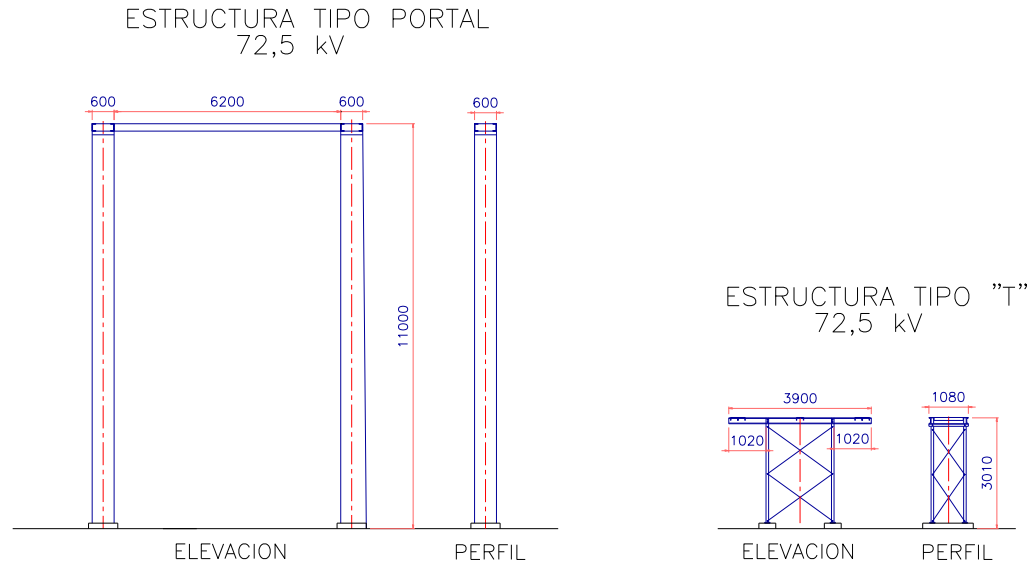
Estructuras Soporte Típicas para Seccionadores de 72,5 kV
